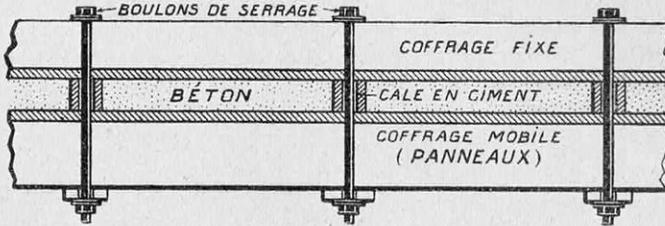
FRAGMENT D'UNE COUPE DE LA VOUTE ENTRE SES COFFRAGES
